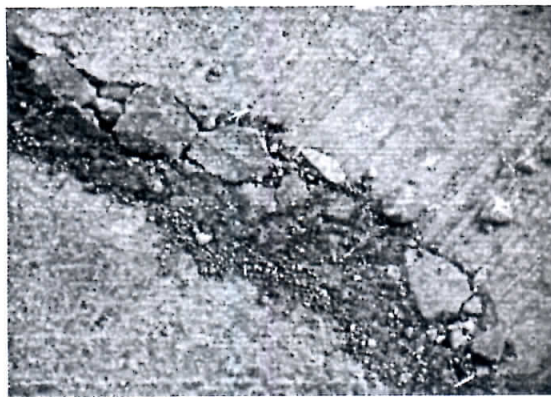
6/03/2015: Solera con emboquillado fisurado en calle Victoria.
